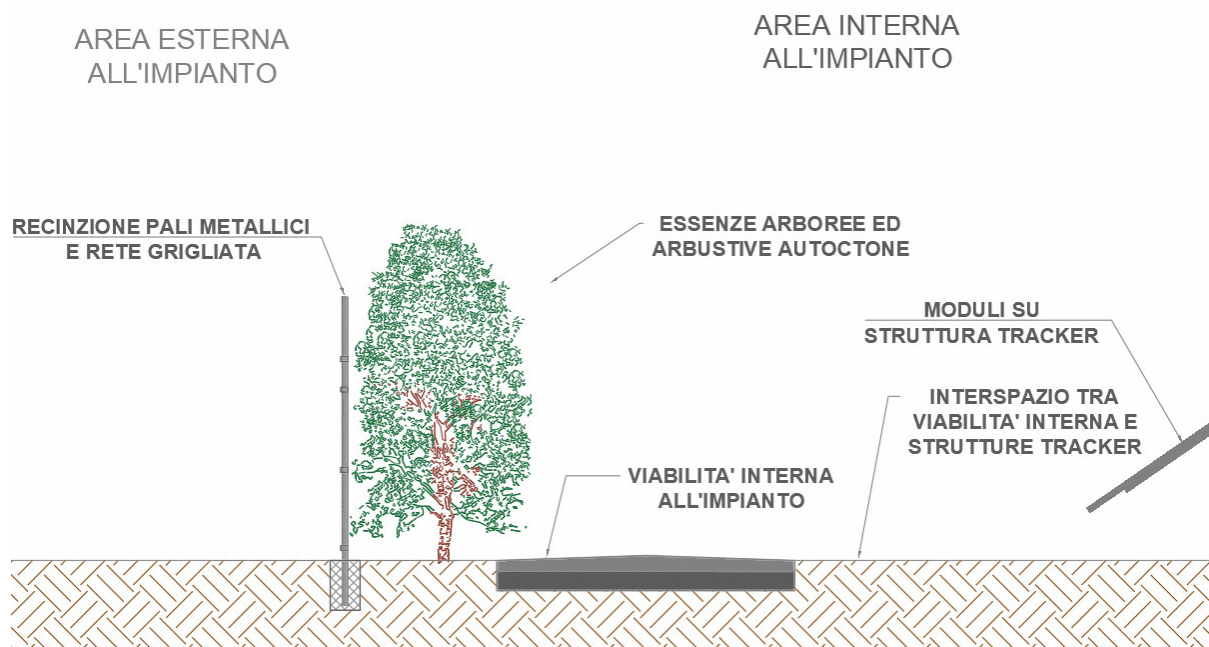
Sezione A-A relativa al dettaglio di planimetria dell'area nei pressi della recinzione: rappresentazione degli spazi nell'area interna all'impianto
